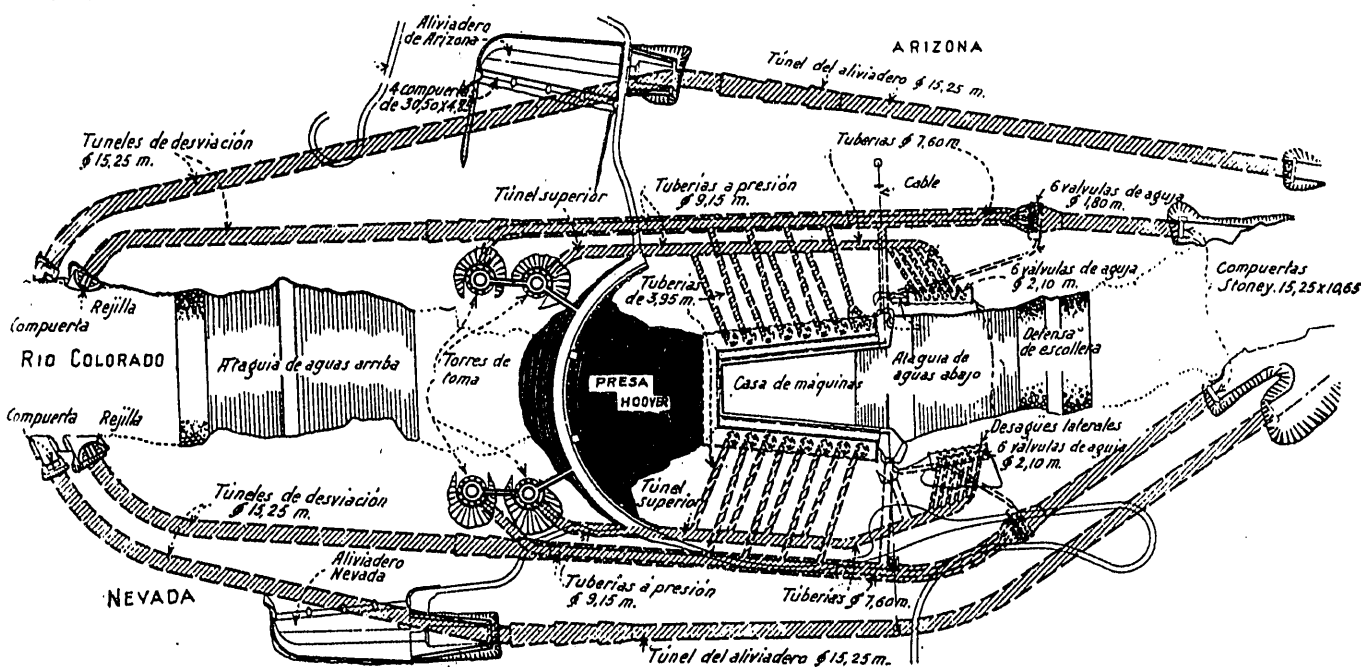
Plano general de la presa Hoover con las construcciones auxiliares
